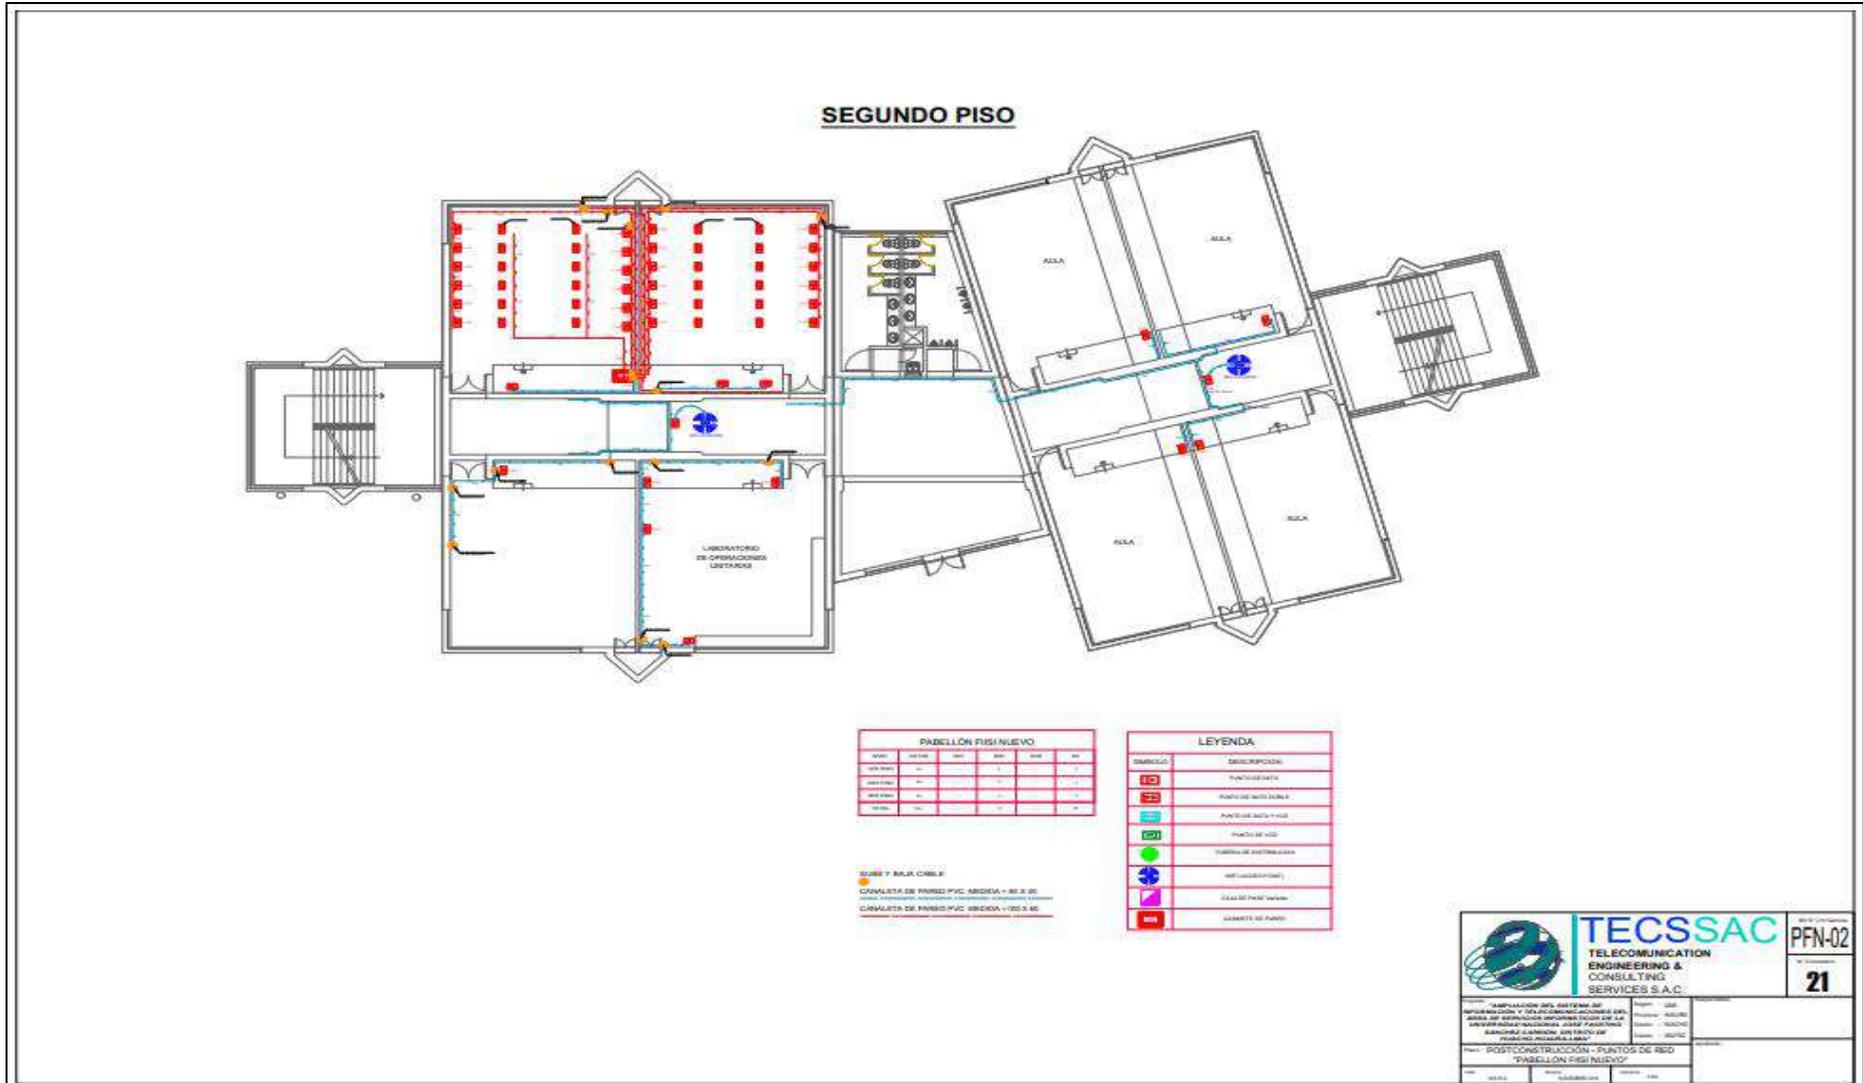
Diseño e implementación de cableado estructurado PISO N° 2
